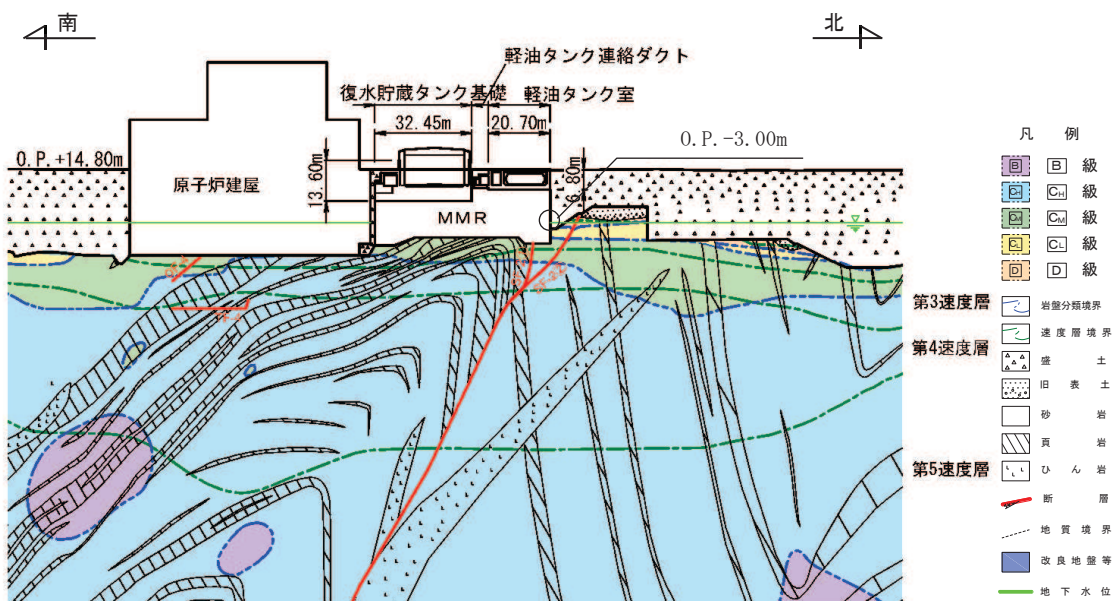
(1) 復水貯蔵タンク基礎 地震時荷重算出用地質断面図 (A-A 断面, 南北)
